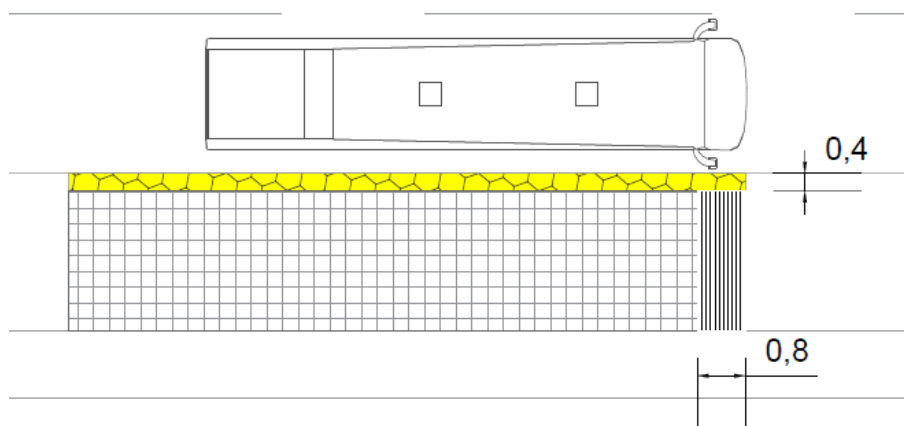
Elementos de pavimentación accesibles en paradas de autobús
